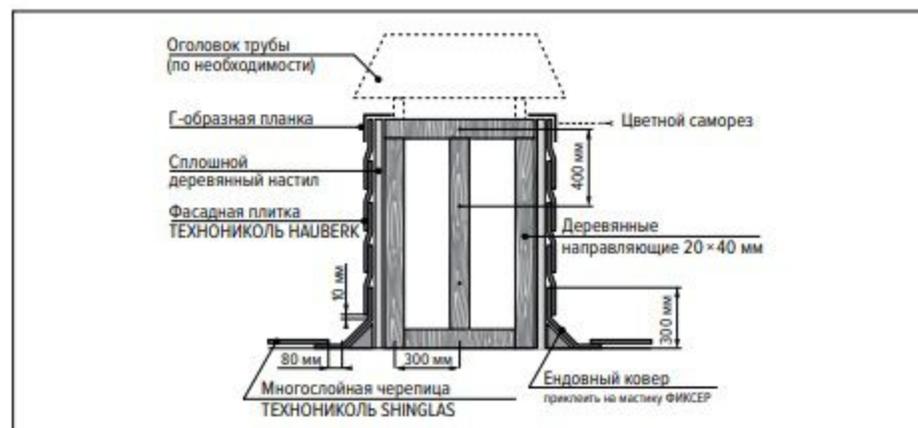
Монтаж фасадной плитки на вентиляционную трубу
